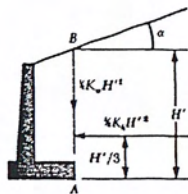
แสดงถึงแรงที่กระทำบนกำแพงกันดินแบบยื่น (Cantilever retaining wall) และกำแพงกันดินแบบน้ำหนักดวง(Gravity retaining wall) โดยใช้สมมติฐานแรงดันดินกิริยาของ Rankine ซึ่งกระทำตามระนาบแนวตั้ง AB ซึ่งลากผ่านจุดปลายด้านหลังกำแพง  $P_p$  เป็นค่าจากแรงดันปฏิกิริยาของ Rankine ซึ่งจะมีค่าเป็นดังนี้
